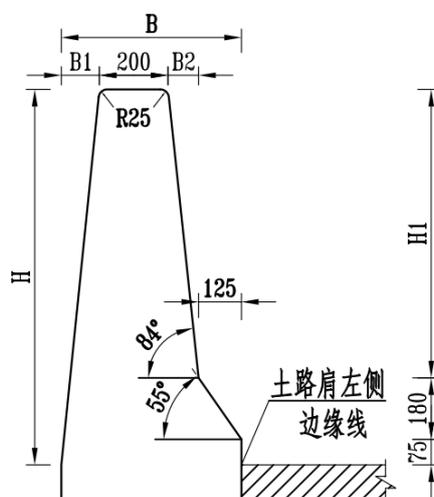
F 型路侧玻璃纤维钢筋混凝土护栏 (尺寸单位: mm)
